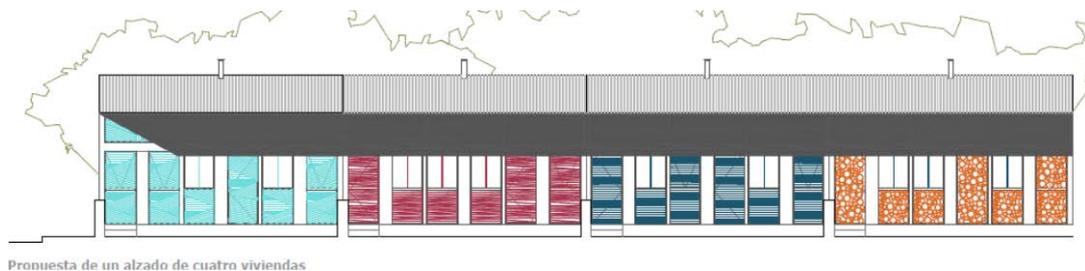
Propuesta del alzado de conjunto de 4 viviendas
